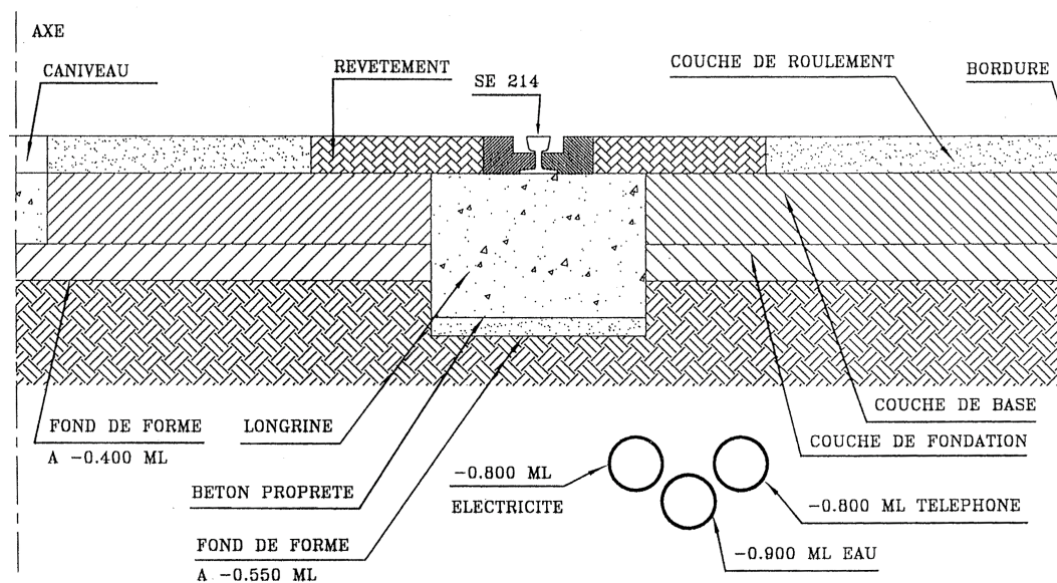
Coupe de la structure de chaussée du TVR de Caen
